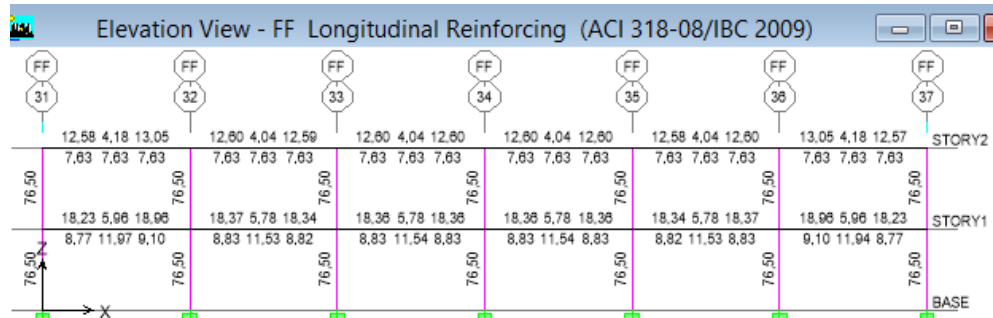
Acero en Vigas y Columnas en el Pórtico FF – Obstetricia - (CEC2002)
